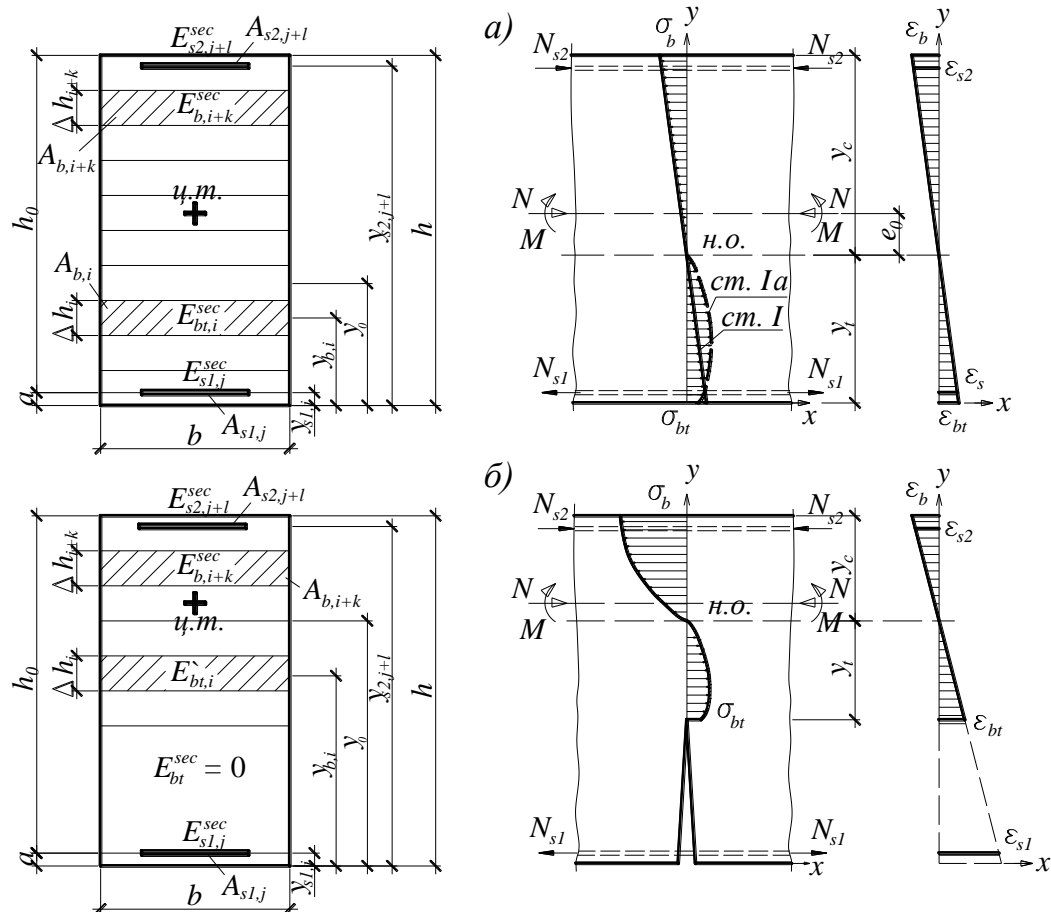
Расчетная схема нормального сечения внецентренно сжатого железобетонного элемента (а) до и (б) после образования трещины
